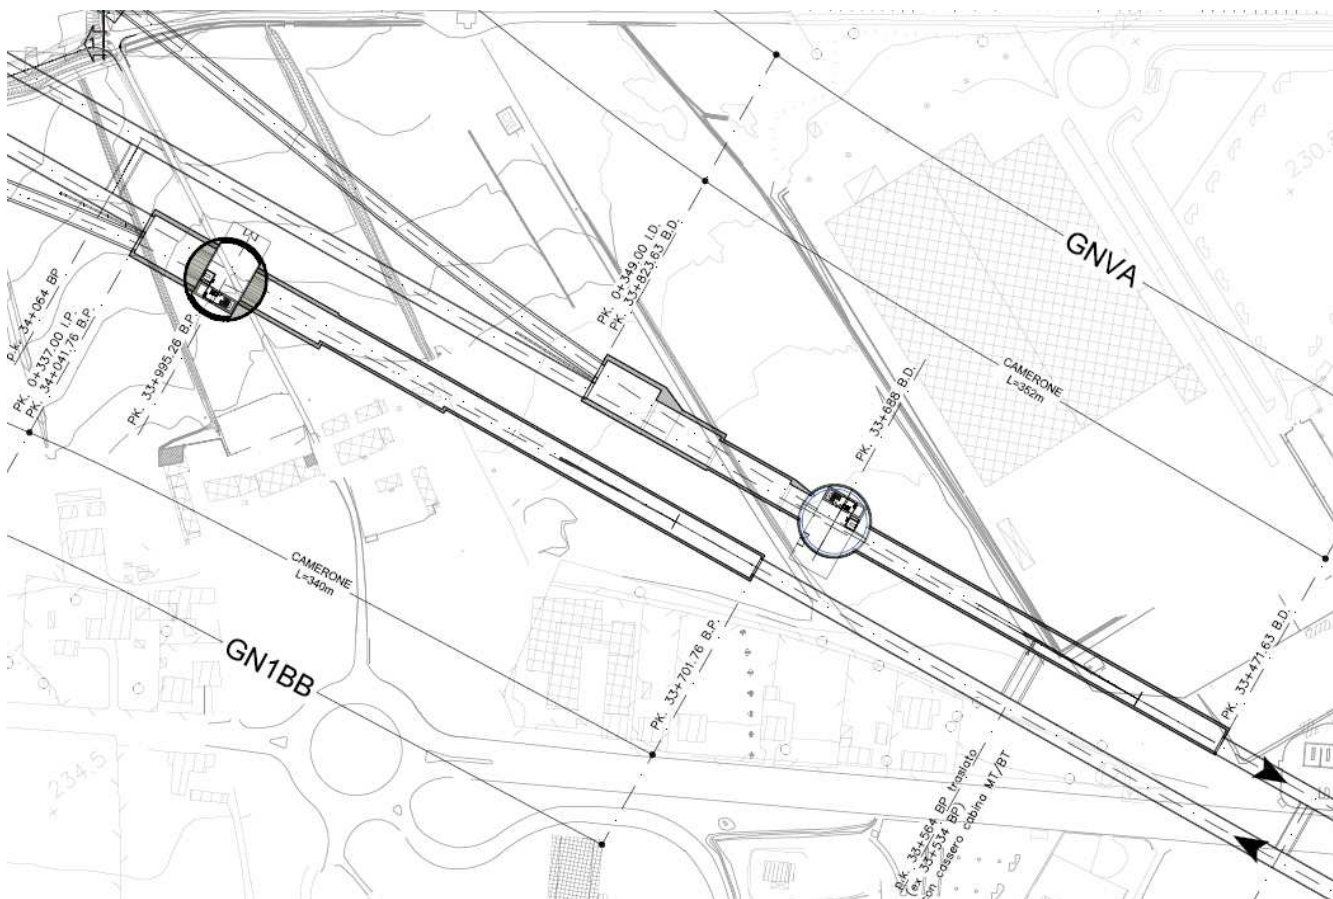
Schema planimetrico dell'ubicazione delle opere dei camerone
